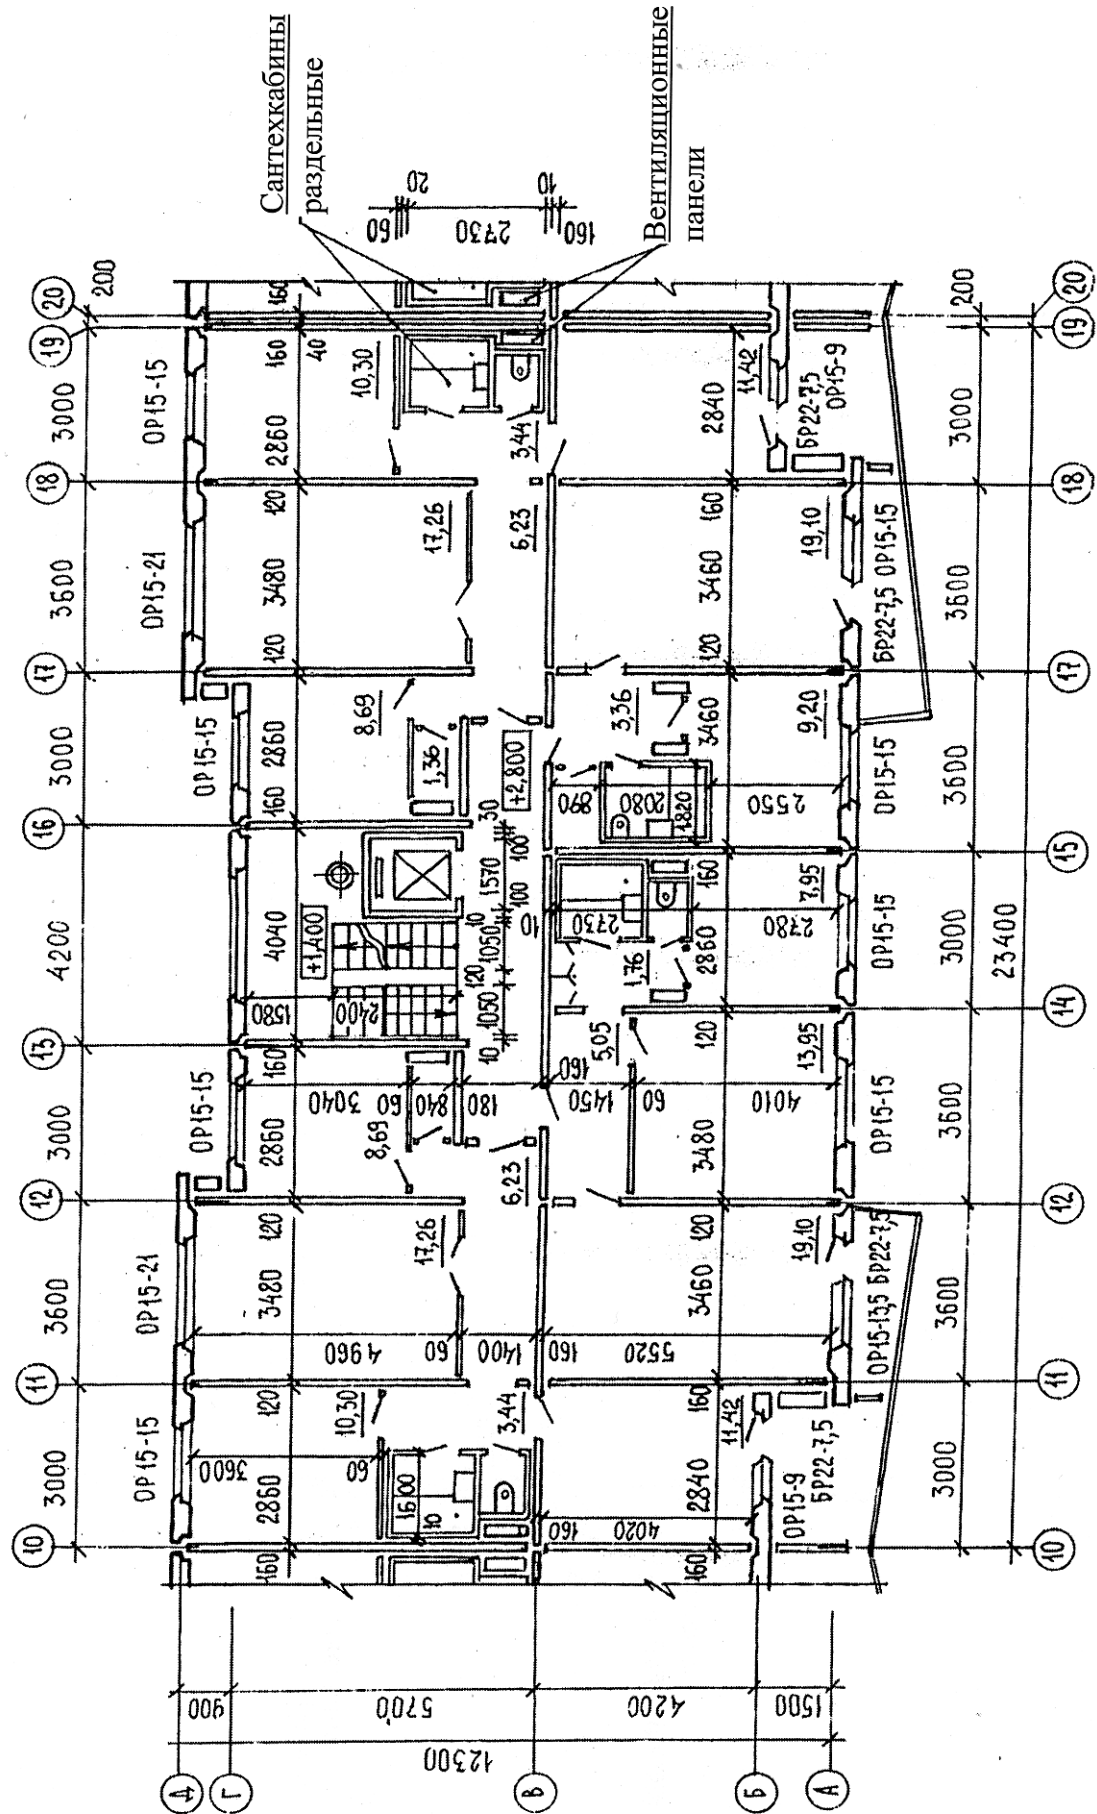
План второго этажа жилого девятиэтажного дома. Перекрестно-стенная конструктивная система с малым шагом поперечных стен (серия 111.90)
